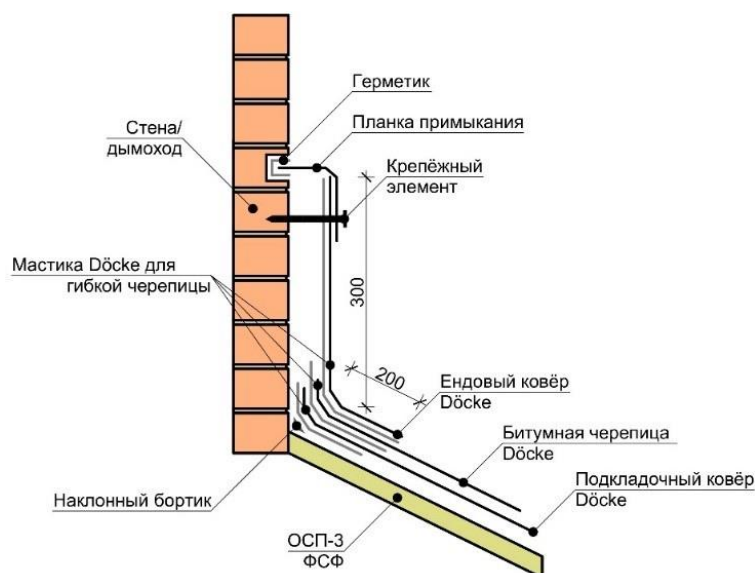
Примыкание ската крыши к выступающим над ней конструкциями под углом от 90° до 120° включительно
